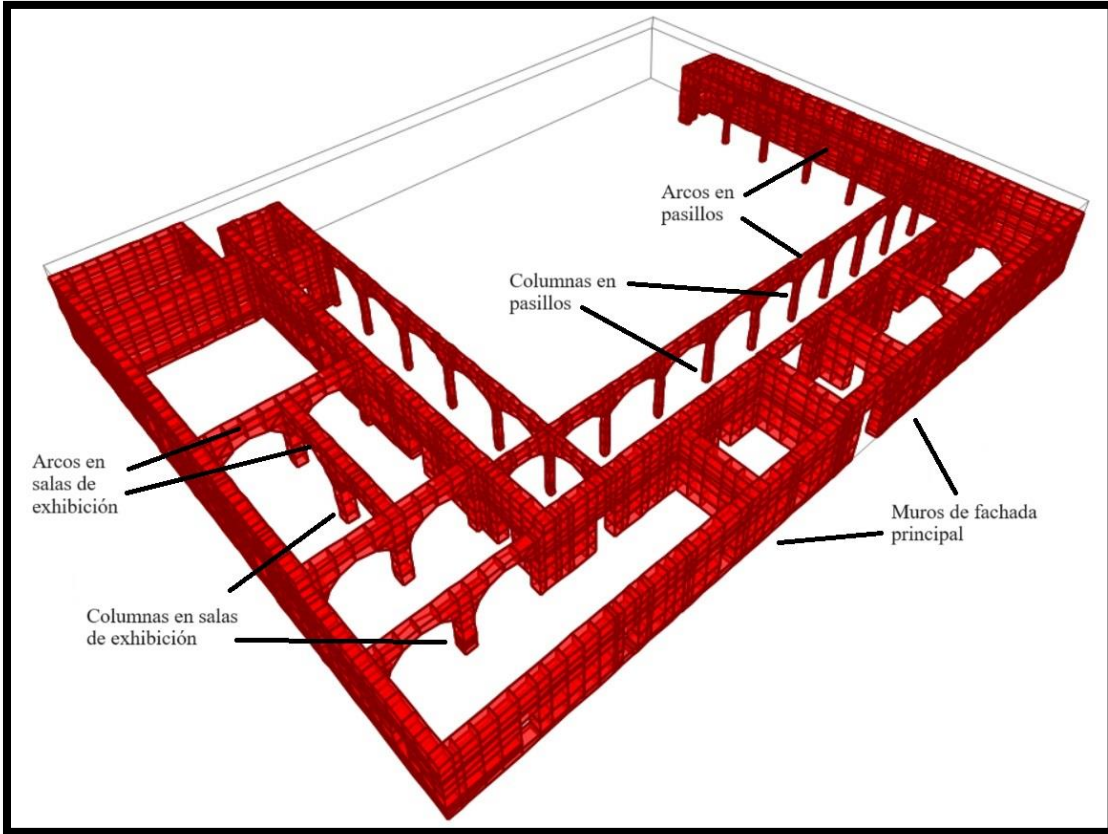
Identificación de los elementos estructurales del Museo de la Insurgencia.
